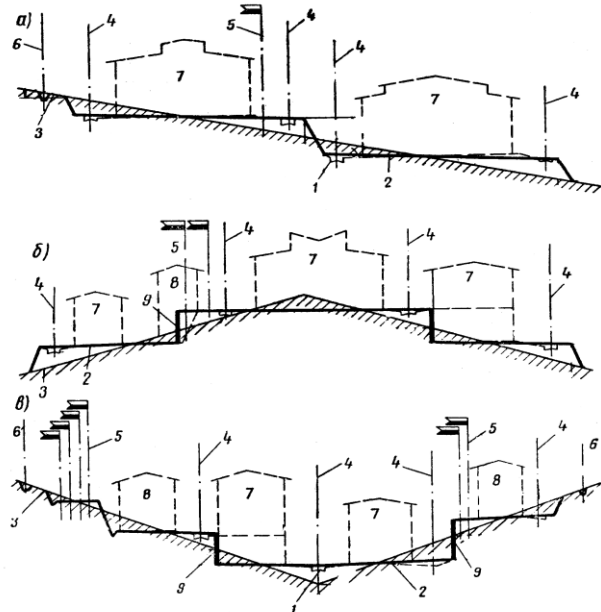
Терасові схеми вертикального планування [53]:
